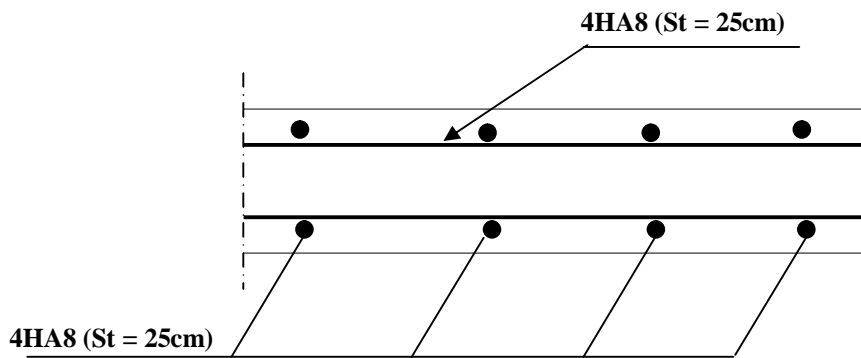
Plan de ferrailage de la dalle de la salle machine
